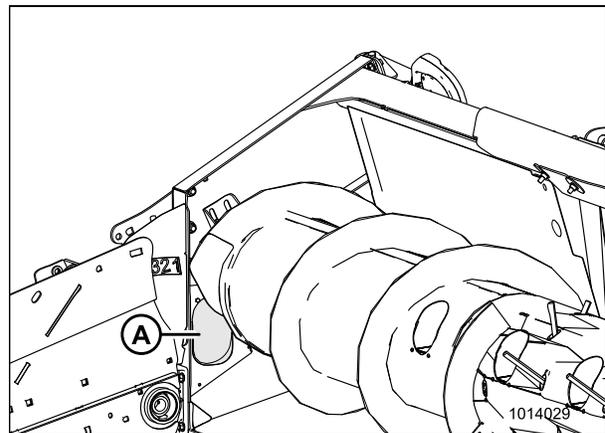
Ensamble del sensor de altura de la plataforma; lado izquierdo
